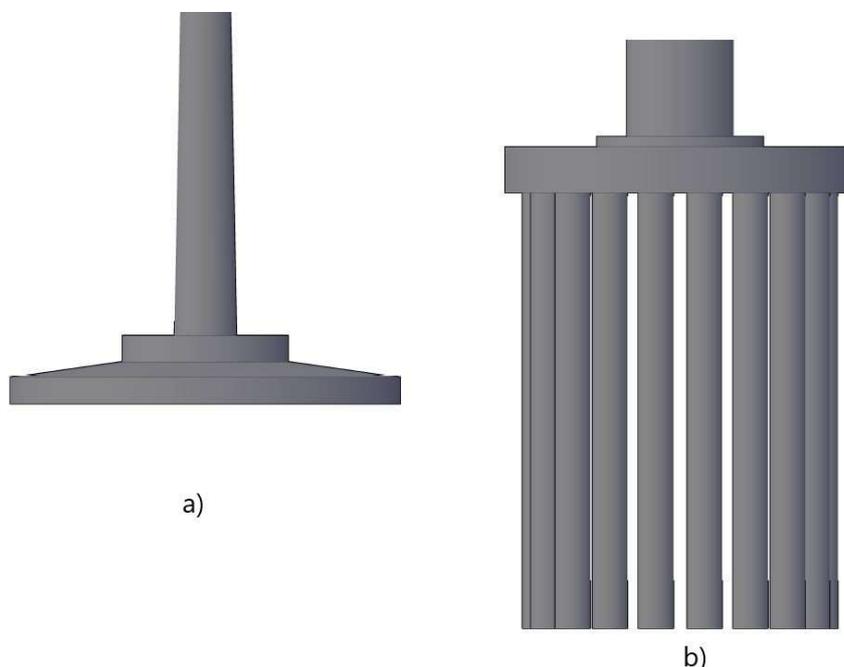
a) Esempio di fondazione diretta. b) Esempio di fondazione profonda
